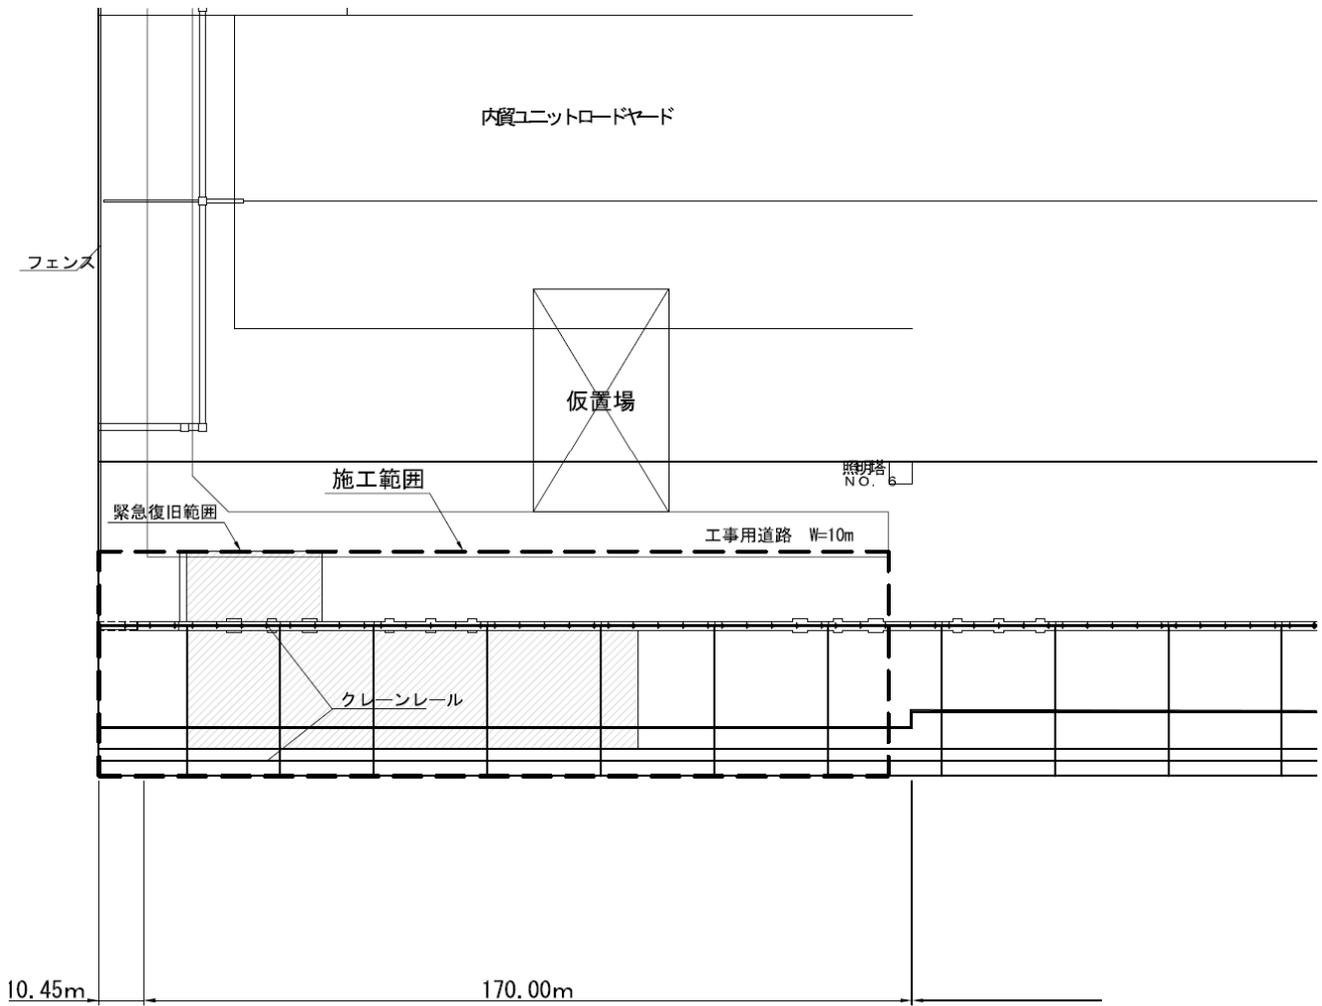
81 No.4 常陸那珂港区_北ふ頭岸壁(-10m)の平面図 (被災後)
